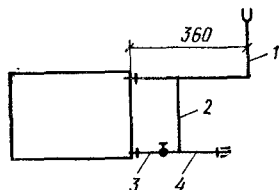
Монтажная схема стояка системы отопления (указанные на схеме узлы 2 и 3 краны для выпуска воздуха на рис. 58.21 и 58.22 не показаны)
